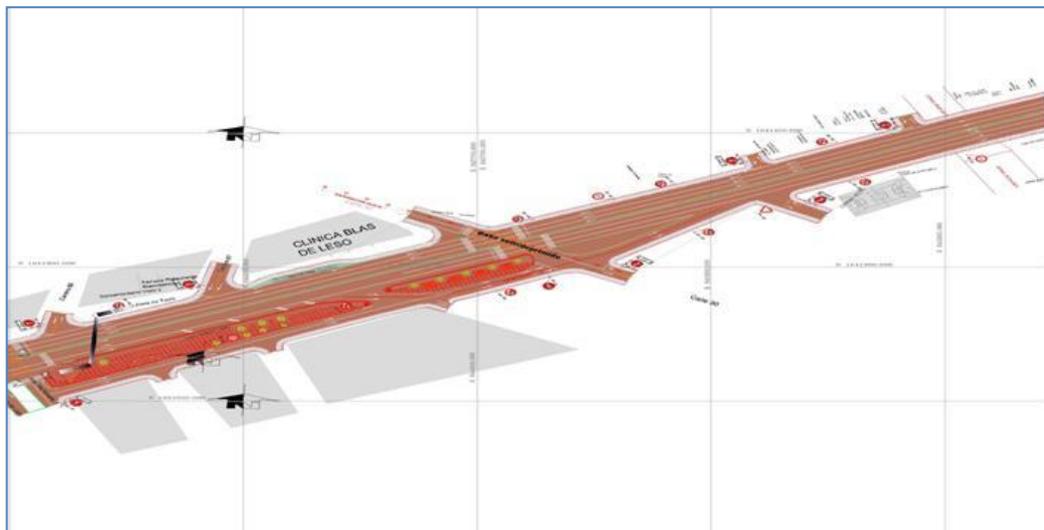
Vista Planta sector 3- Transversal 54⁵³
